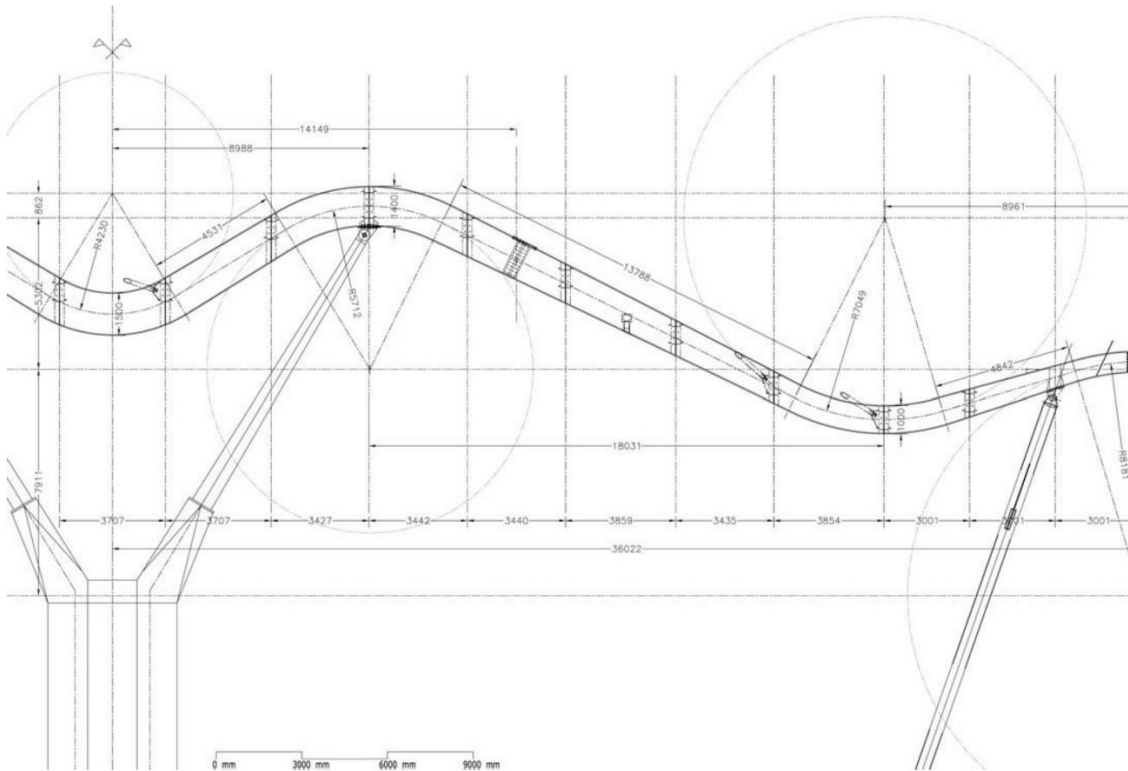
| Alzado acotado de una viga principal. (TC Cuadernos)
